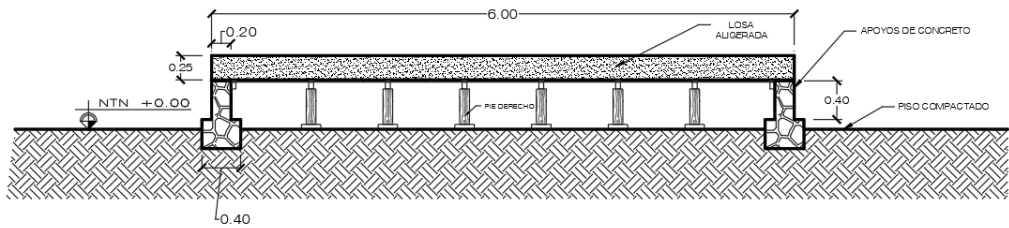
Vista de perfil del encofrado de las losas aligeradas.
